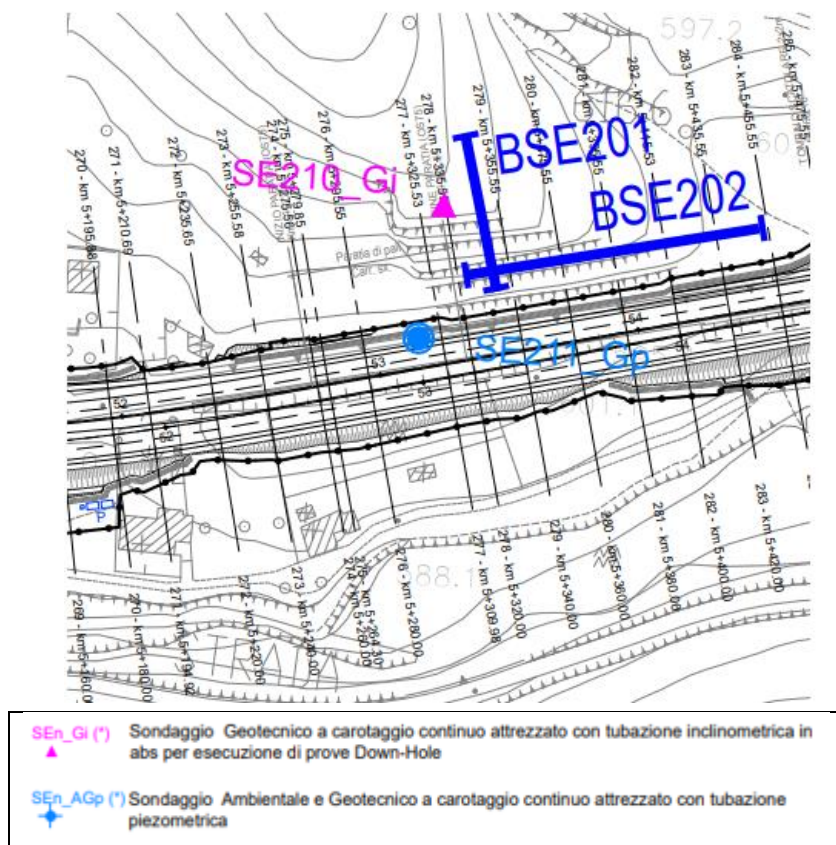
Planimetria con ubicazione della strumentazione di monitoraggio.
